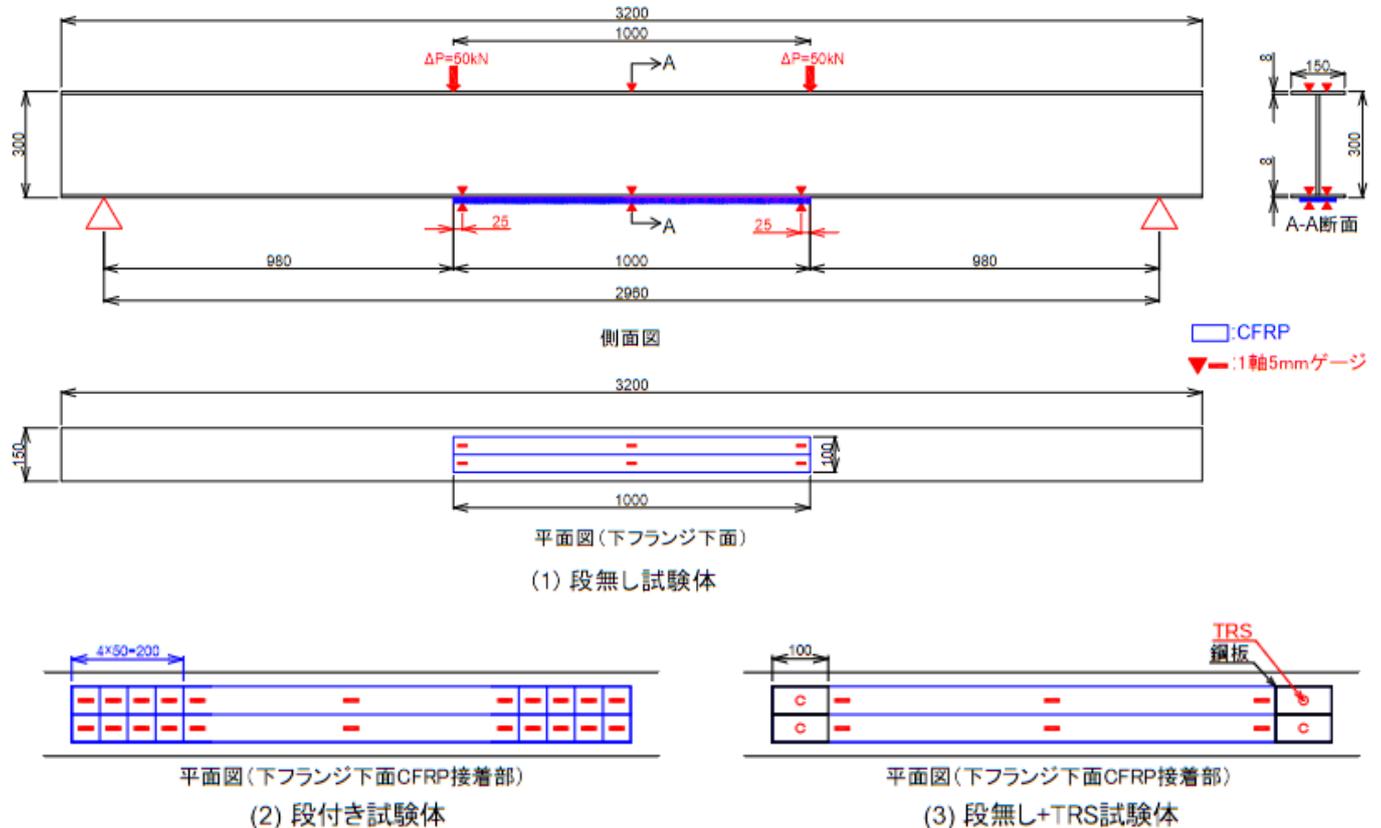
試験体の形状と寸法、載荷位置とゲージ貼り付け位置
